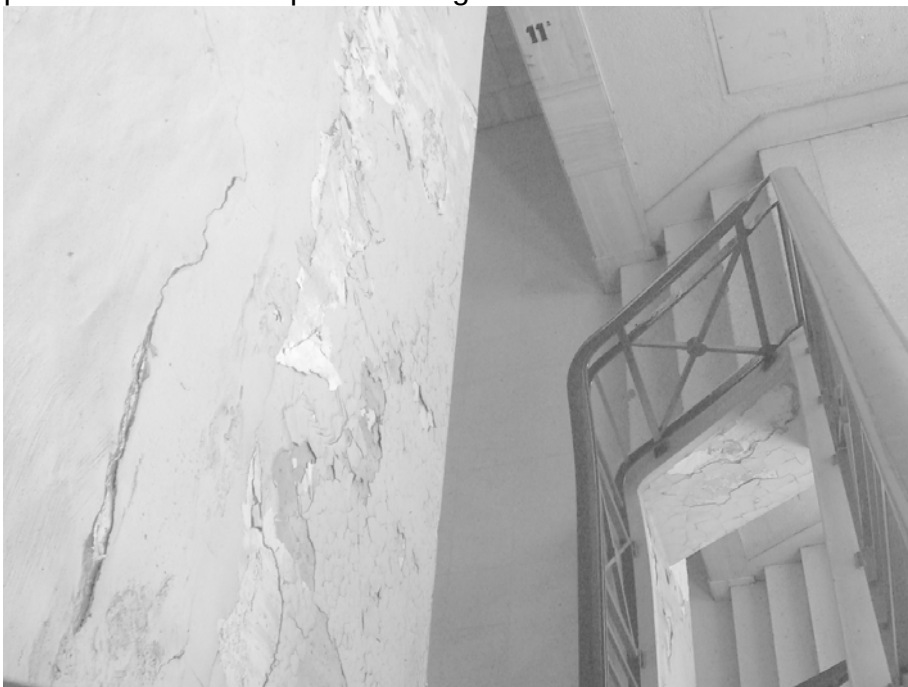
En la presente vista se puede observar una grieta en la pared del palier de la escalera y daños producidos por el agua.
